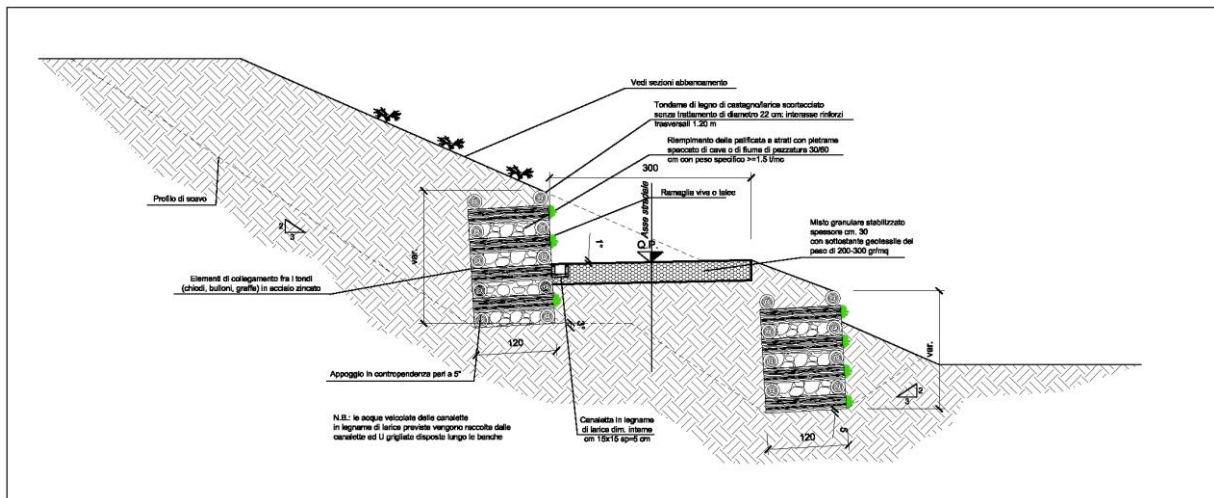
Viabilità pista lungo le banche – Sezione tipo
